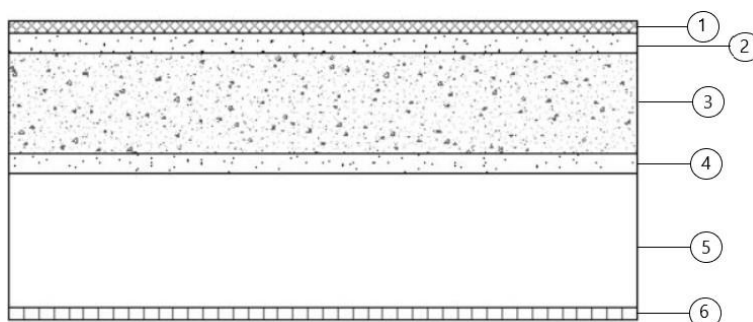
Pormenor da constituição do pavimento intermediário das instalações sanitárias
